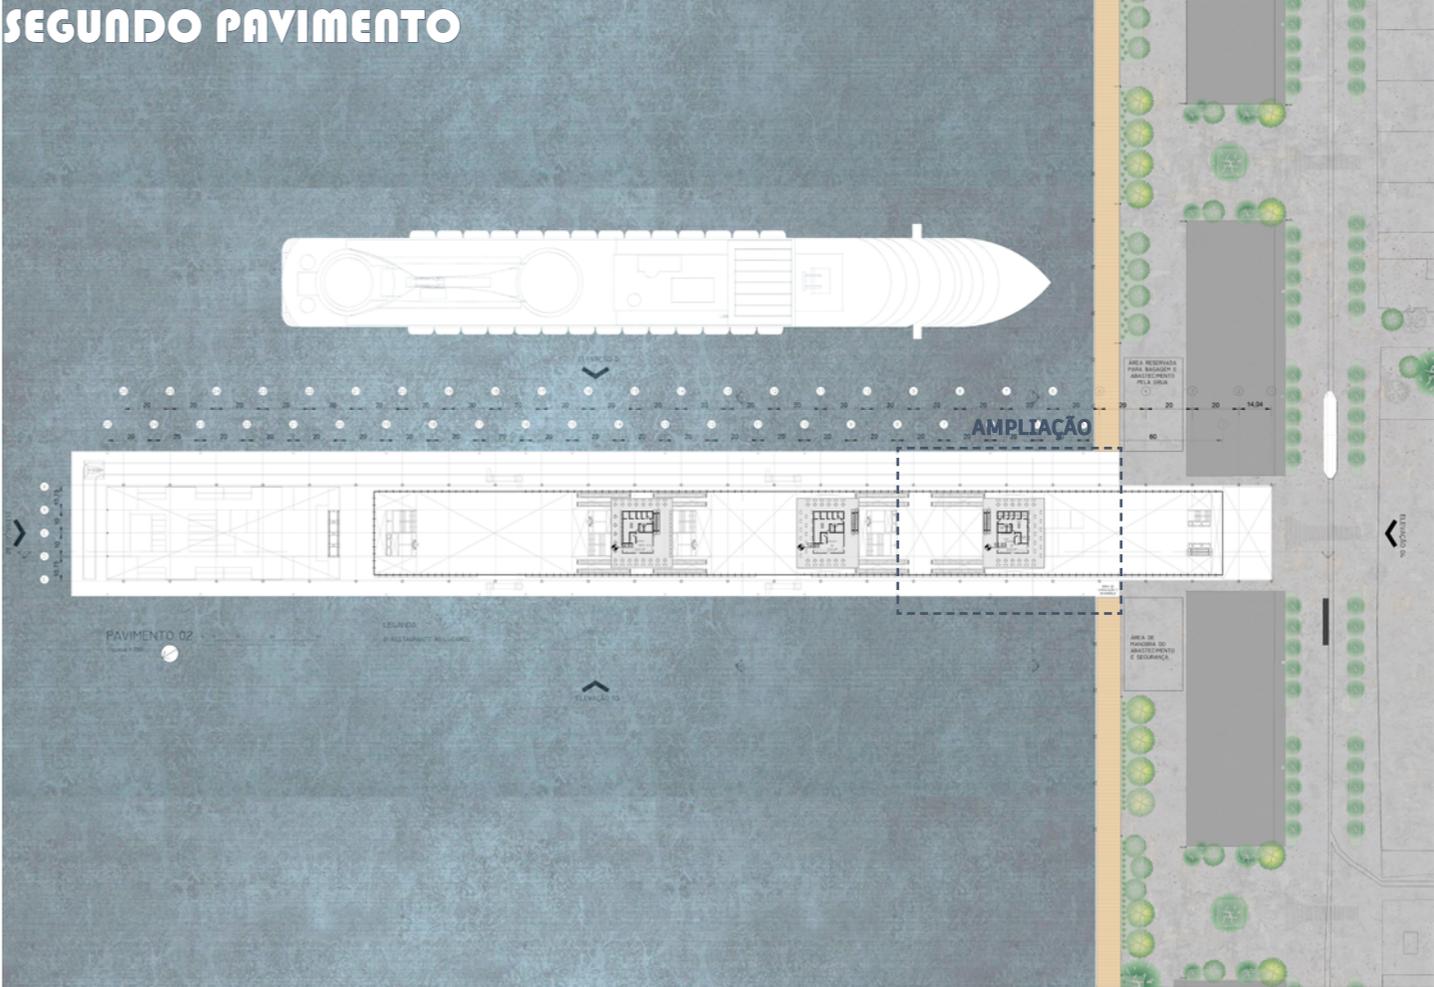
Planta do segundo pavimento. Fonte: Autoria própria
